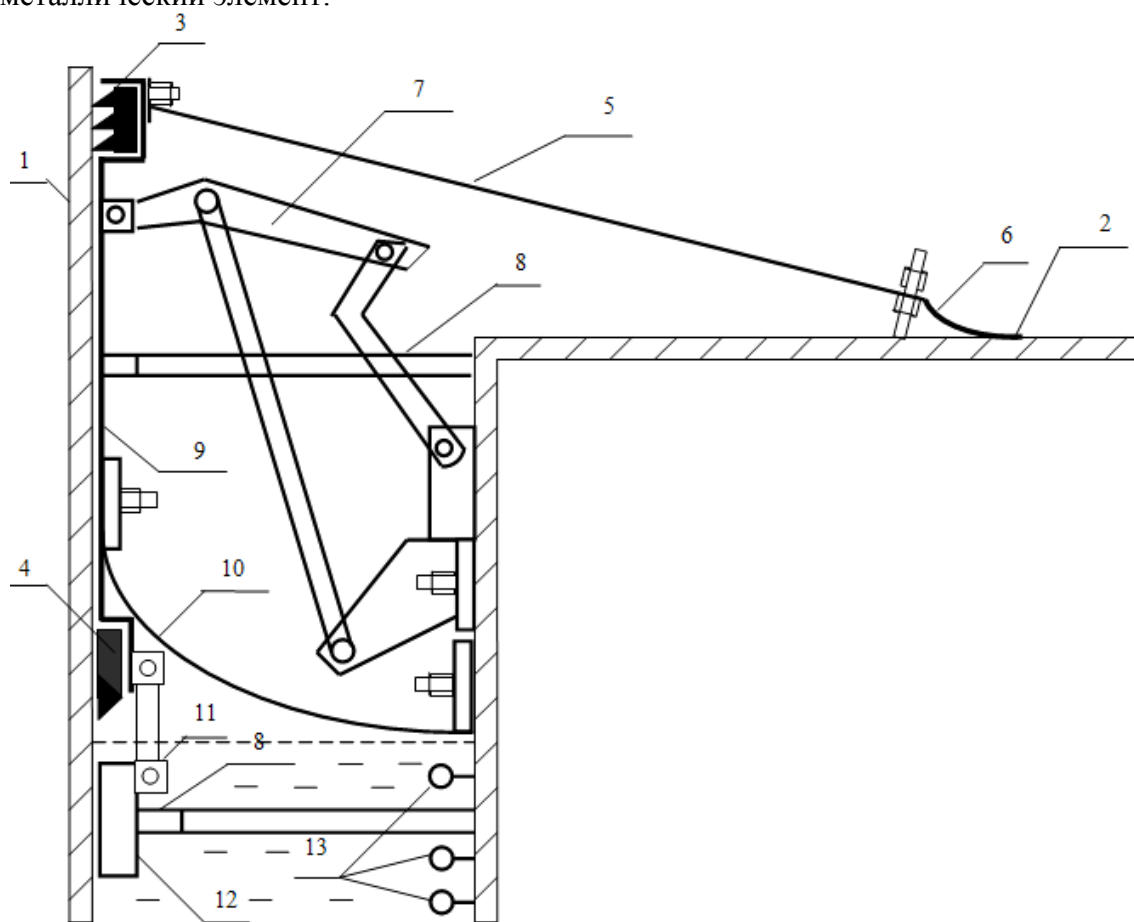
Конструкционная схема уплотняющего затвора плавающей крыши резервуара с шарнирно-стержневой системой:
